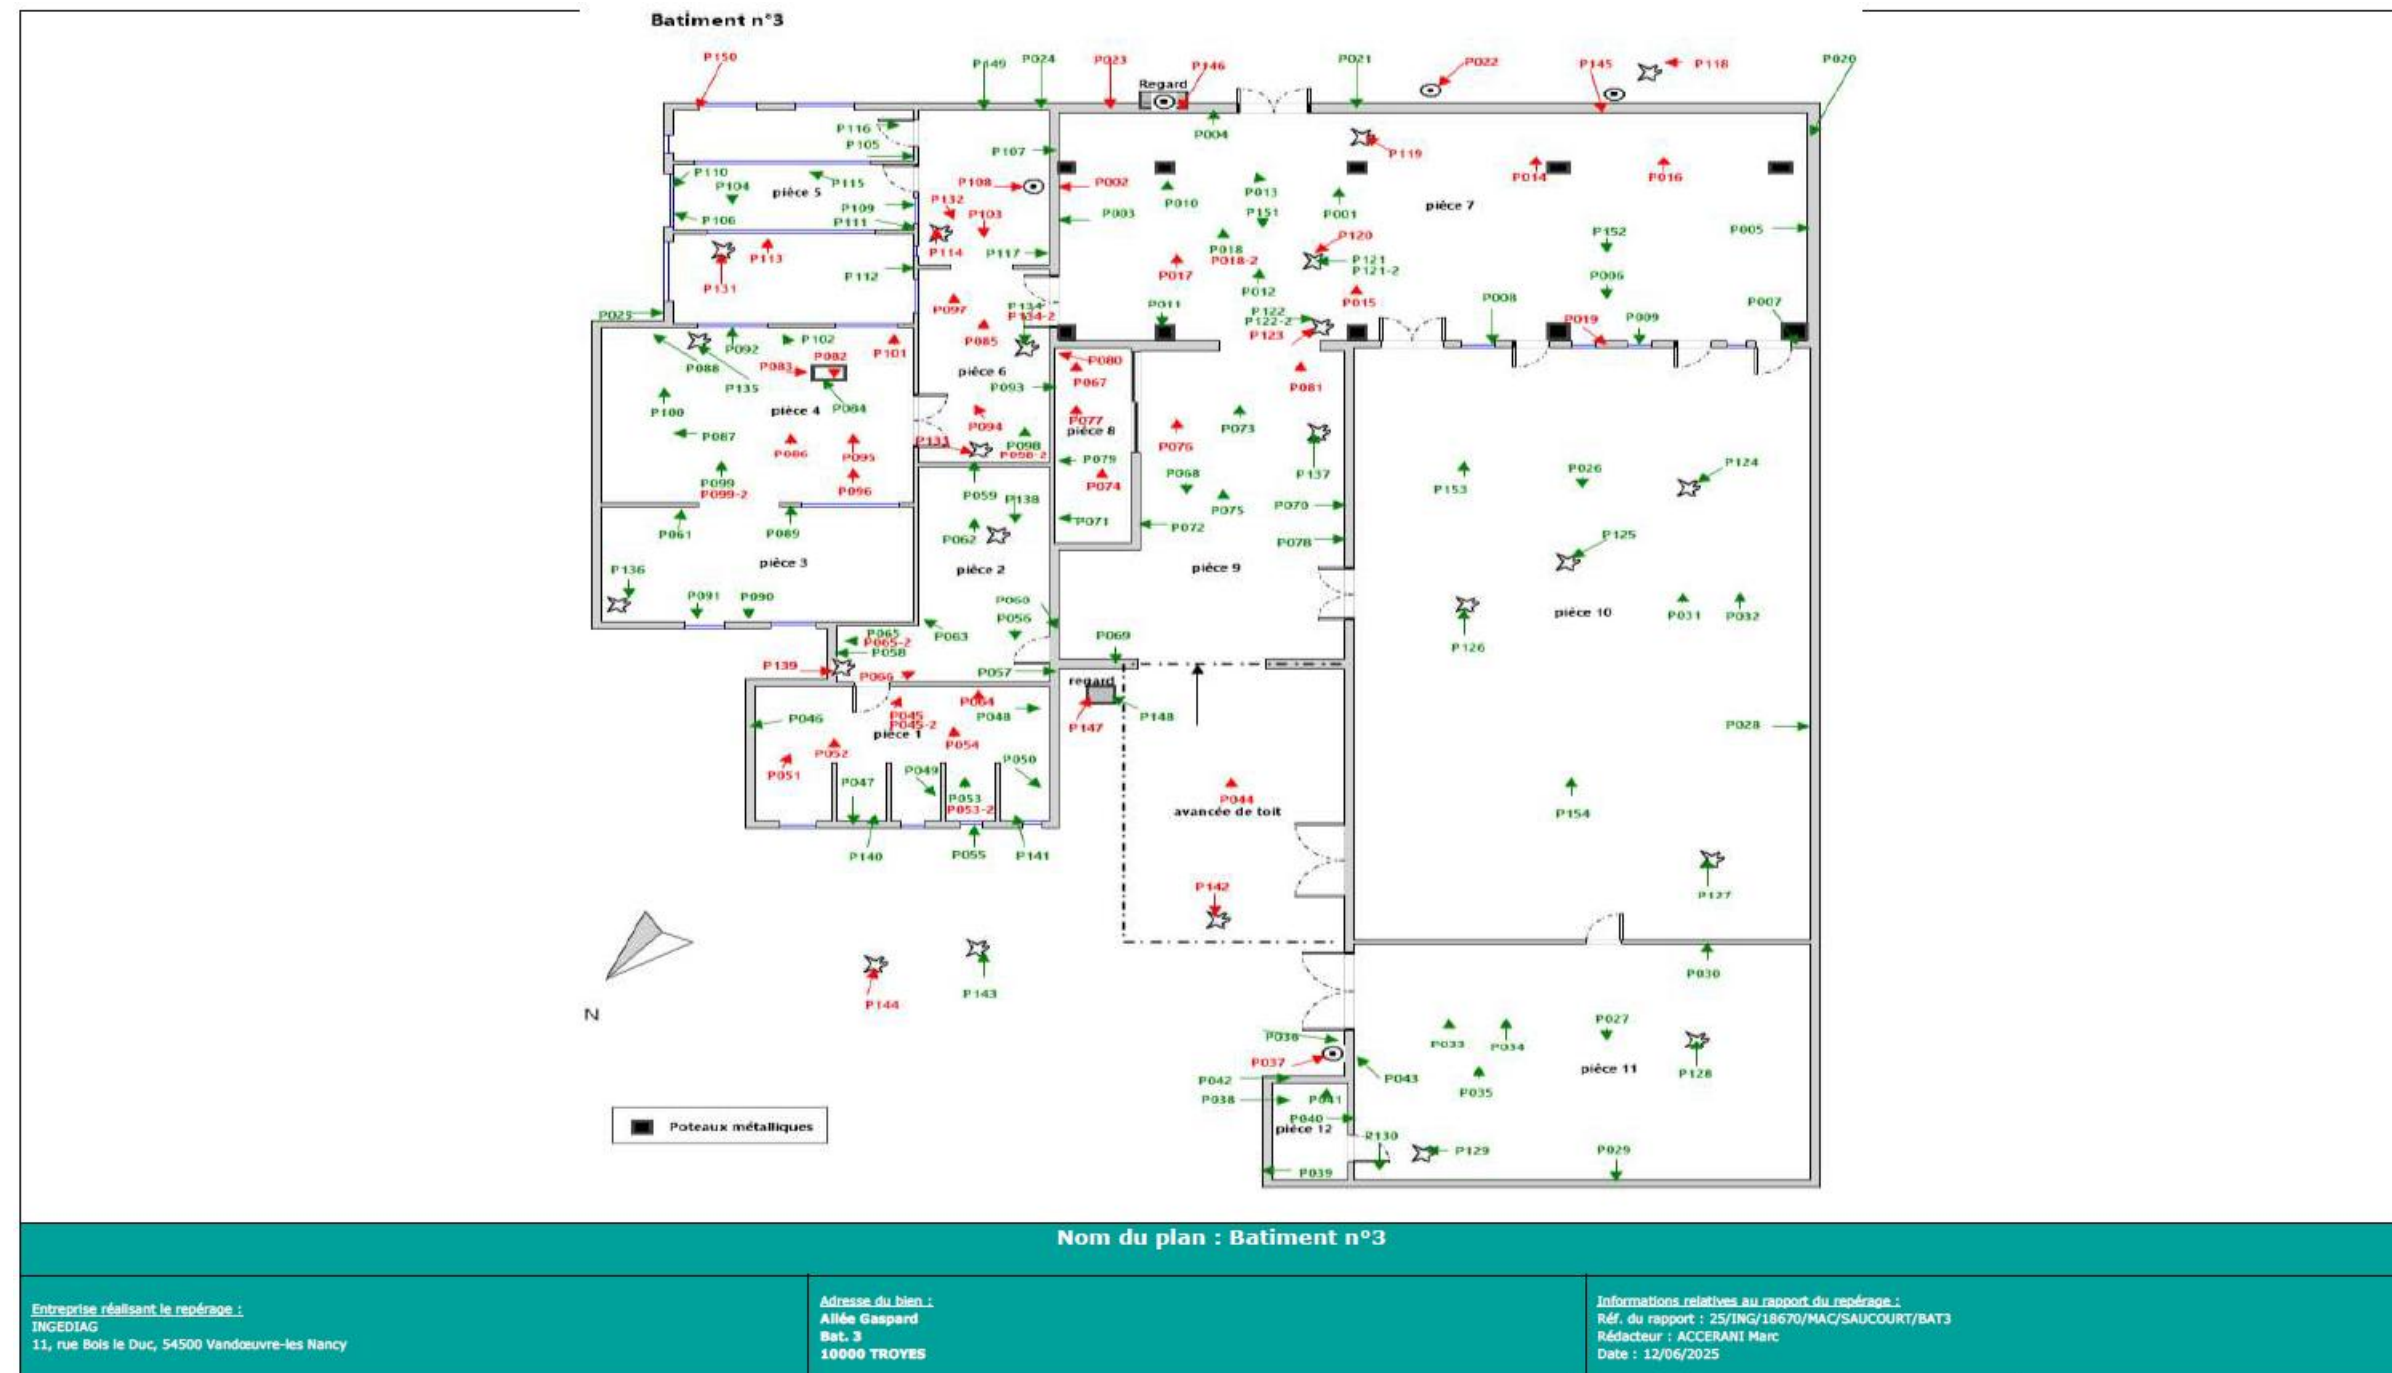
Plan générale des prélèvements amiante dans le bâtiment 3
